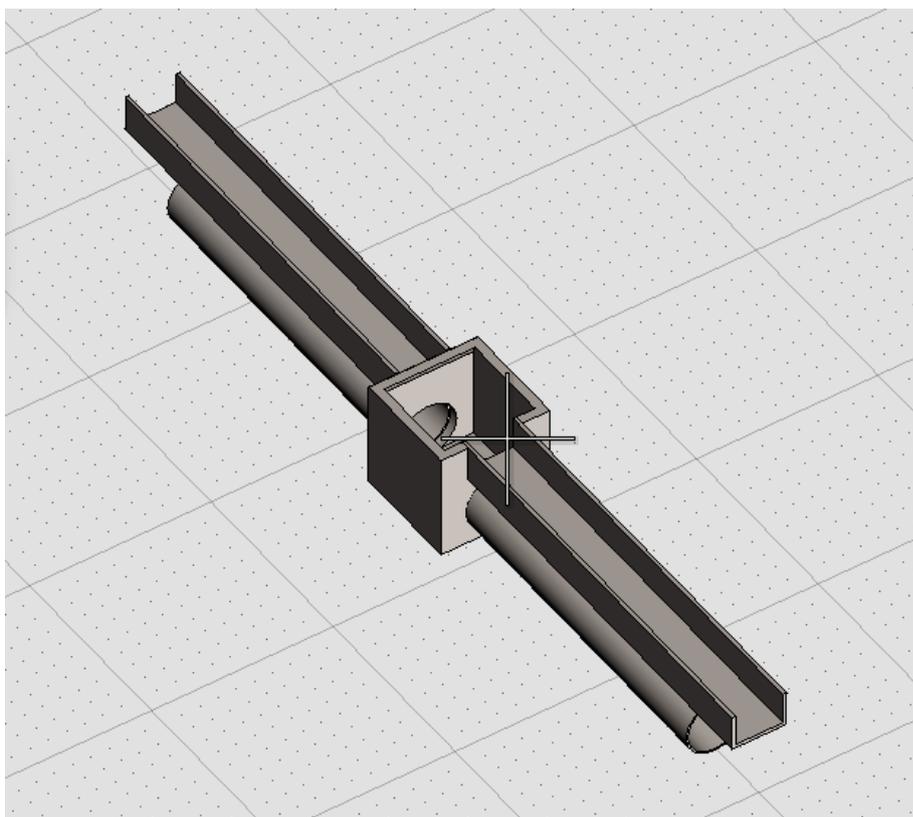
e seguenti: particolari delle canalette trasversali in legno previste dal progetto. La staffatura nella parte inferiore della canaletta favorisce le attività di manutenzione e pulizia
